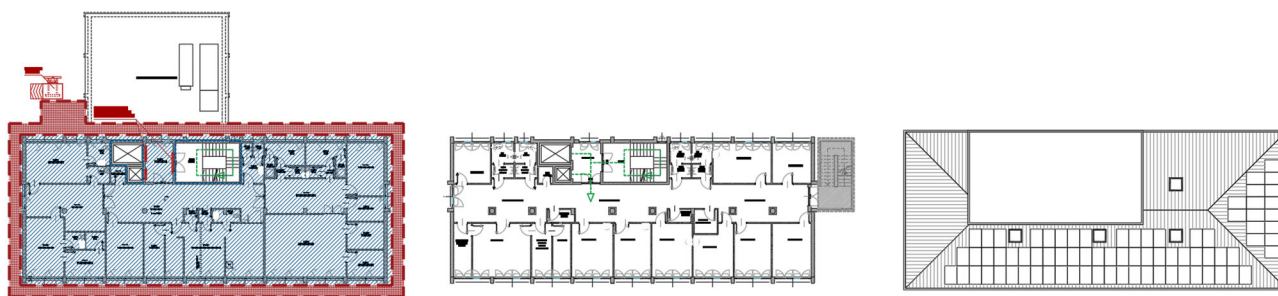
Planimetria del piano terreno con individuazione delle aree di cantiere – Fase 2
